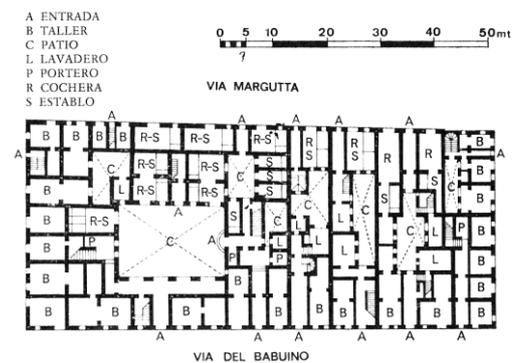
7. Planta baja de una de las parcelas entre vía del Babuino y vía Marautta
